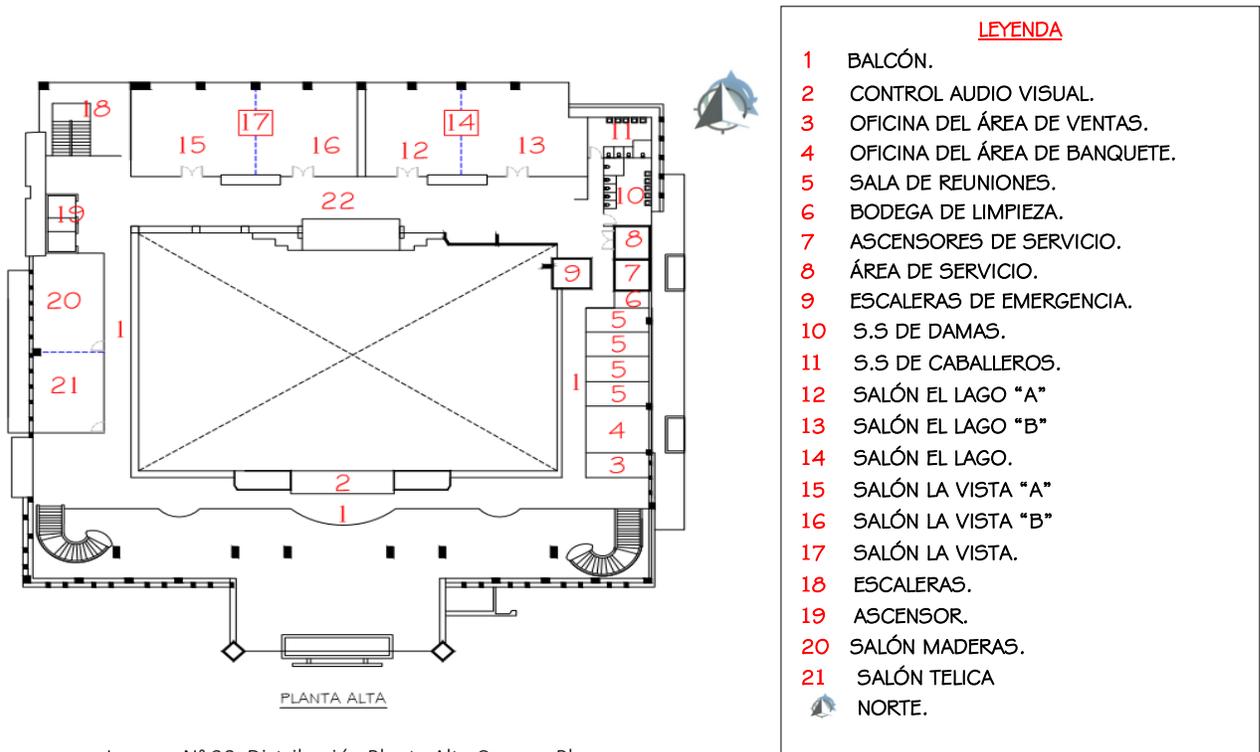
Distribución Planta Alta Crowne Plaza
